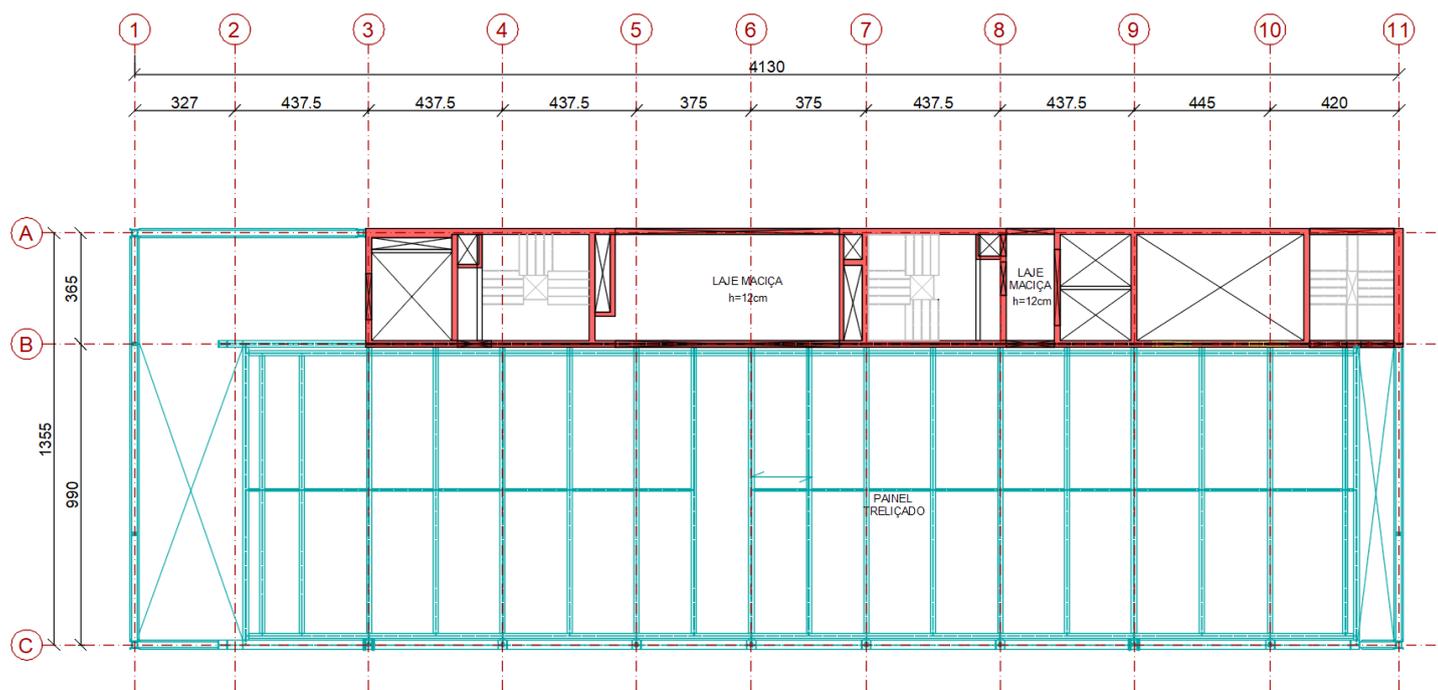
Planta de Arquitetura - Sétimo pavimento: exposição temporária
